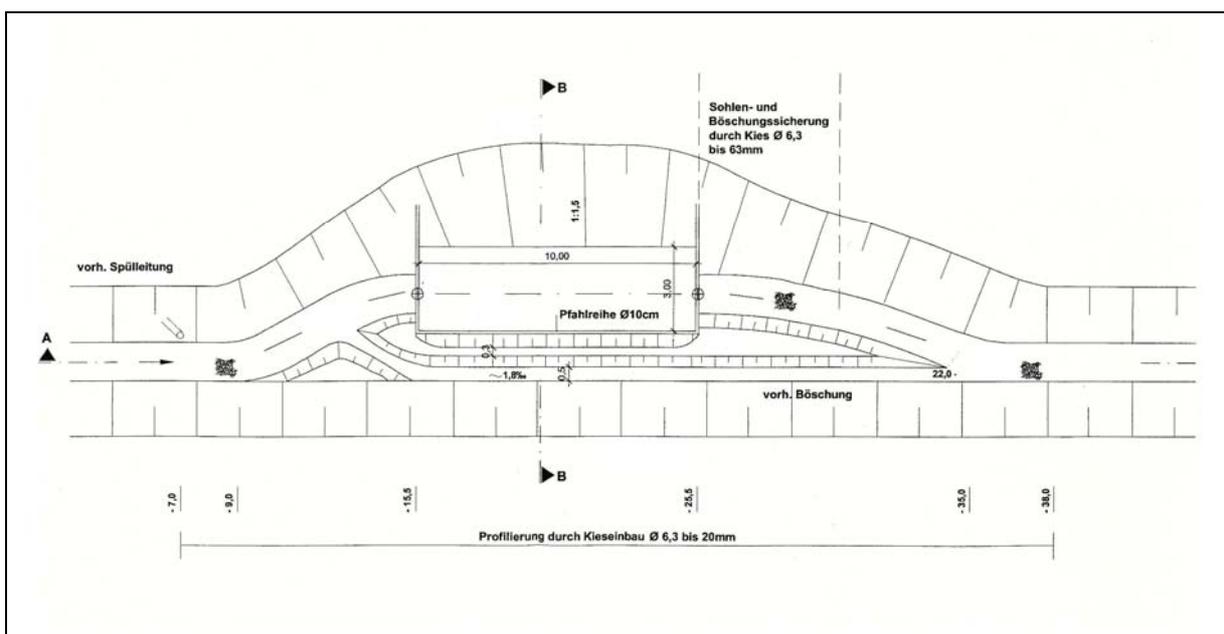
Grundriss Sandfang an der Fuhlau (Ing.-Büro Heuer-Jungemann)
